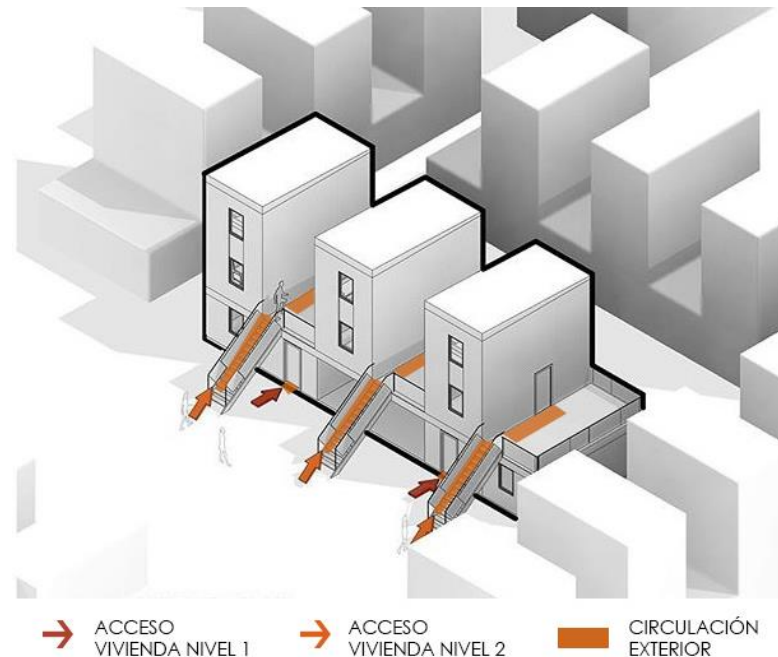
Proyecto Quinta Monroy, Iquique, Chile.
